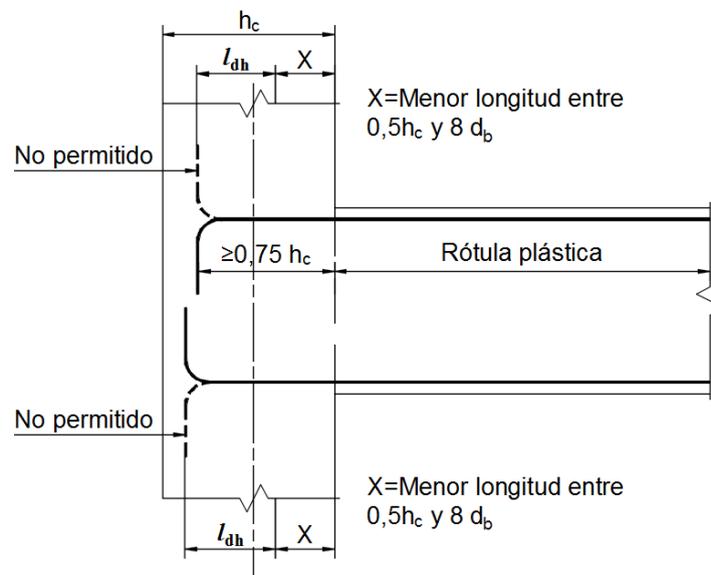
Anclaje de la armadura longitudinal de una viga cuando la sección crítica de formación potencial de rótula plástica está en la cara de la columna.
